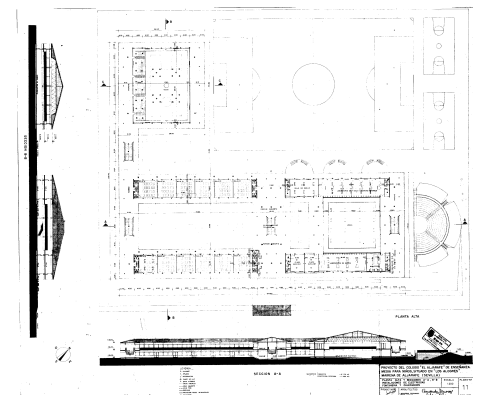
Primera Planta y secciones abatidas. Planos originales. Fondo Fundación Aljarafe.
